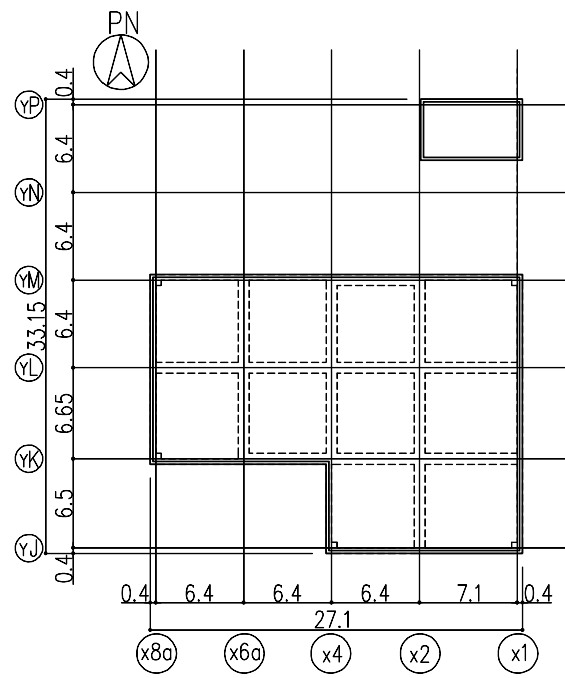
屋上階平面図 (G. L. +15.4) (单位: m)
